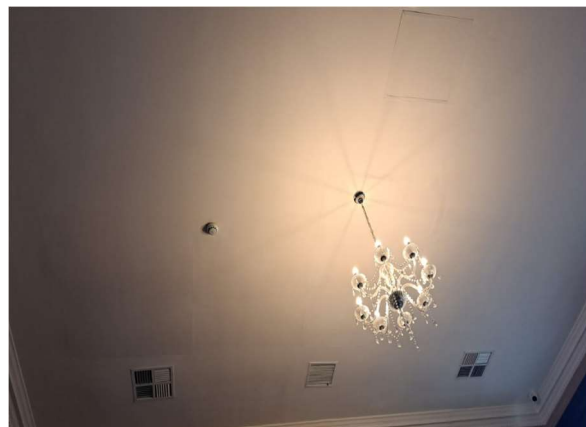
Reparação forro de drywall, sala biblioteca, térreo.
